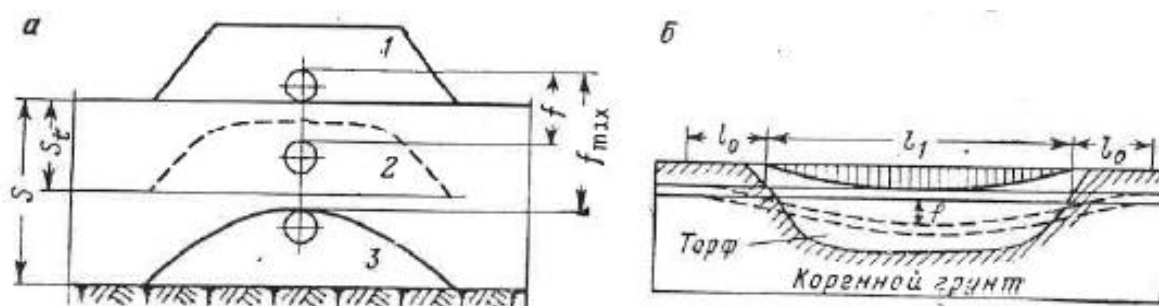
Схема изменения положения трубопровода в насыпи
